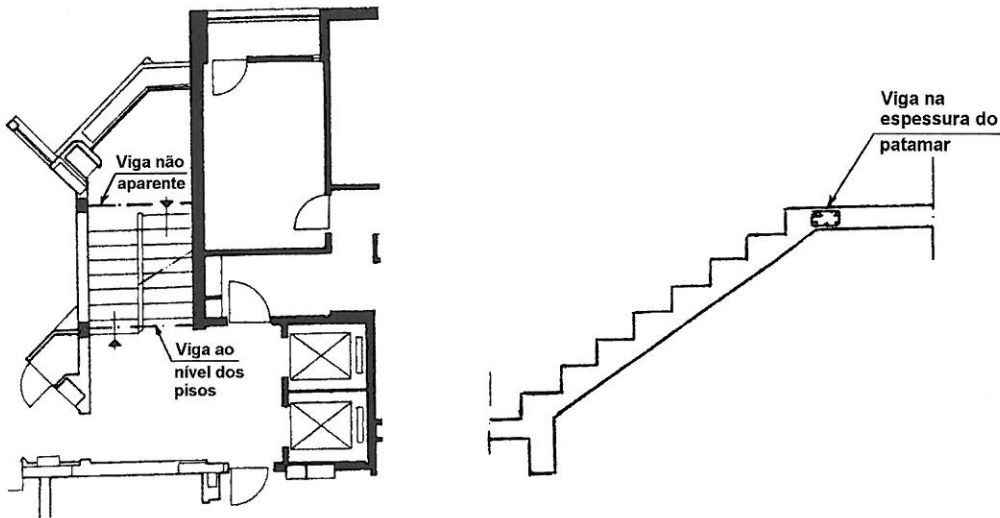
Vigas ao nível dos pisos e reforço não aparente das lajes do patamar intermédio.
